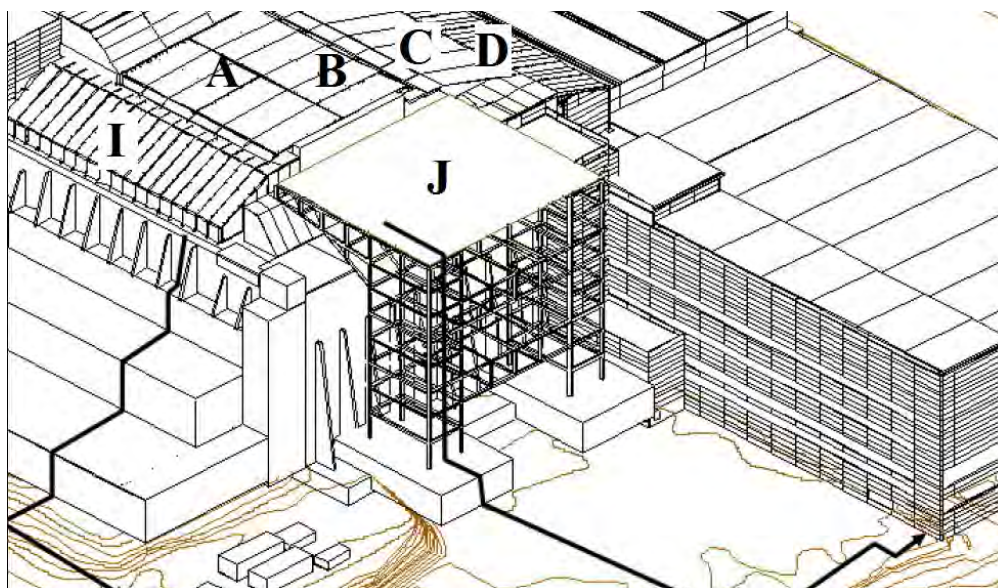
2004г. Внешний вид «Укрытия» с запада после выполнения работ по стабилизации. Буквами указаны конструкции, которые предлагается демонтировать: легкая кровля ЦЗ зала (А), трубный настил ЦЗ под легкой кровлей (В), южные панели покрытия (С), южные щиты-ключики (D); северные щиты-ключики (I); ферма, установленная при стабилизации.
